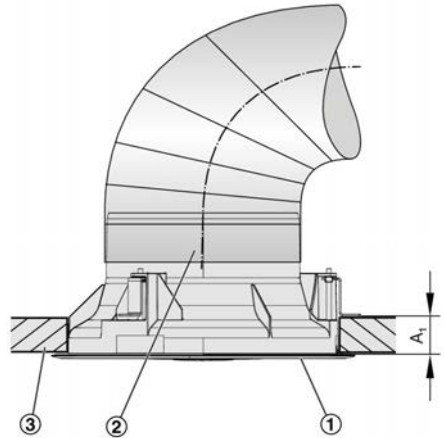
Deckenbündiger Einbau mit Anschlussstutzen
